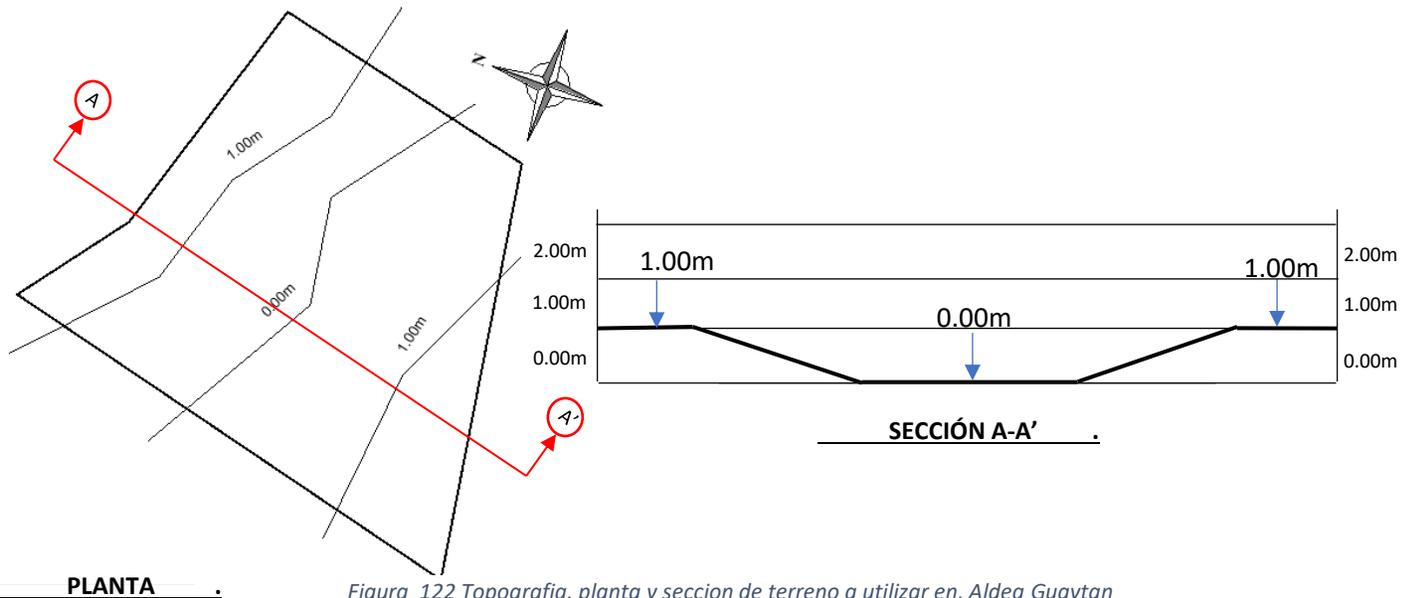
Topografía, planta y seccion de terreno a utilizar en, Aldea Guaytan
